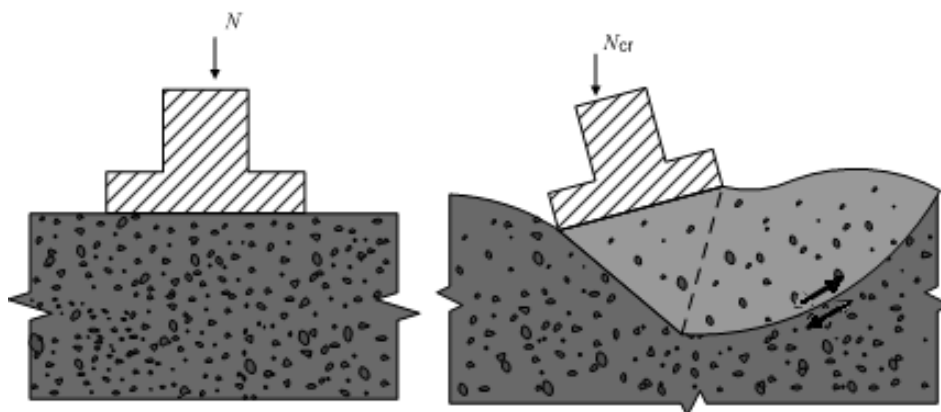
Схема потери устойчивости грунтового основания фундамента
